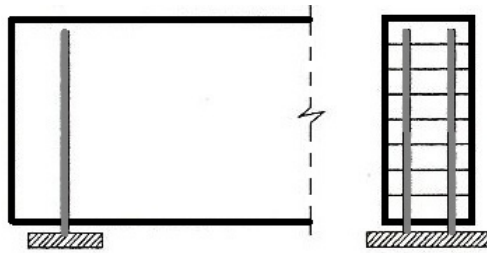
Barras de refuerzo en apoyos de vigas de madera.
